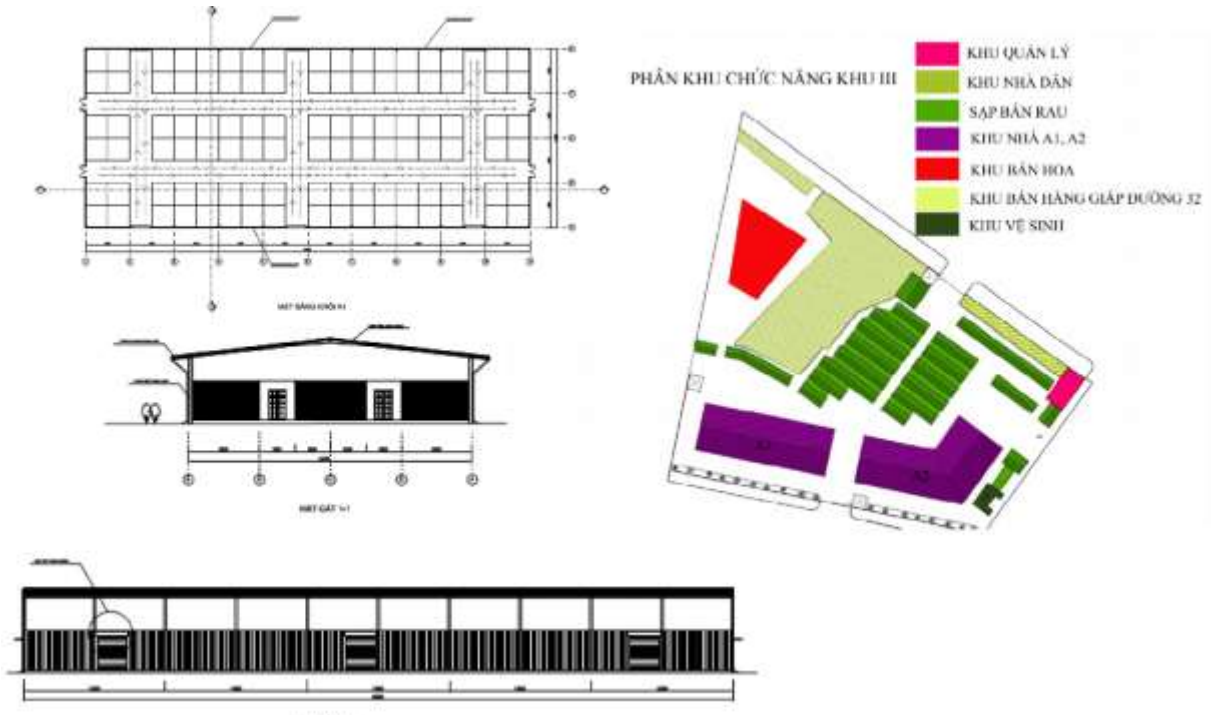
Chợ đầu mối Minh Khai-MBTT
